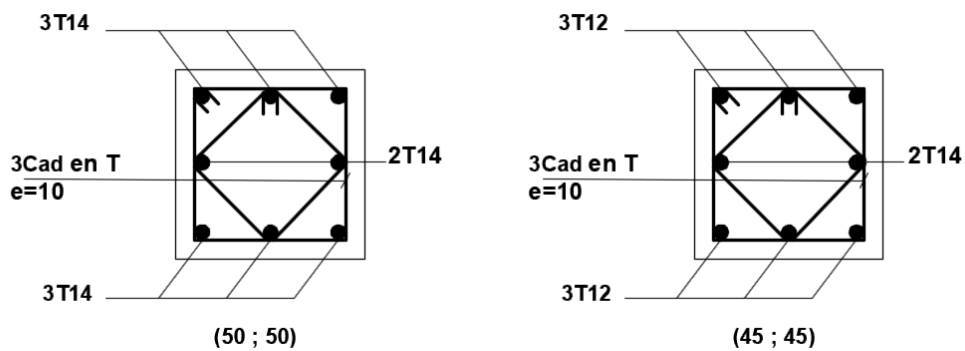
ferrailage des poteaux 40x40 ; 45x45
